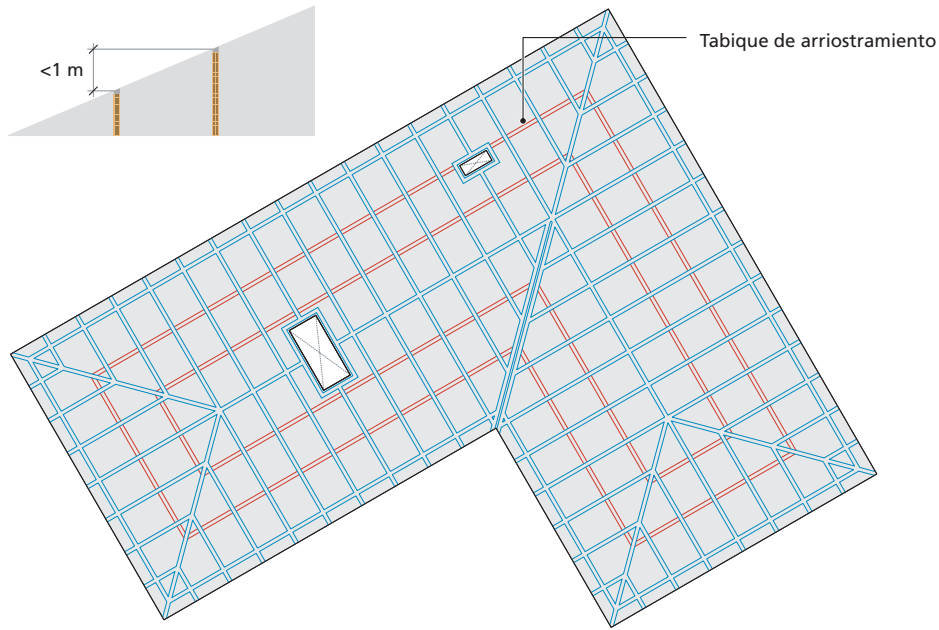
Replanteo de tabiques palomeros perpendiculares al alero en cubierta inclinada sobre forjado
